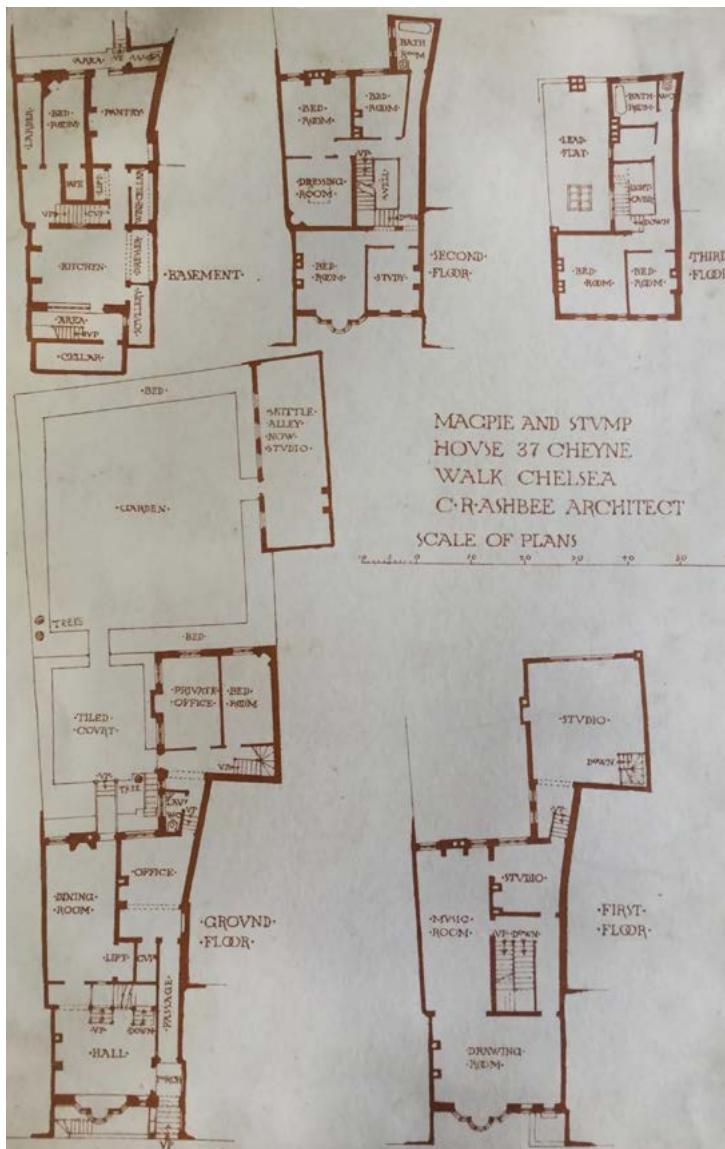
Charles Robert Ashbee, *Magpie and Stump house*, 37 Chelsea Walk, Chelsea, Londra, planimetrie (NAL, Ashbee Fotograf Album).
